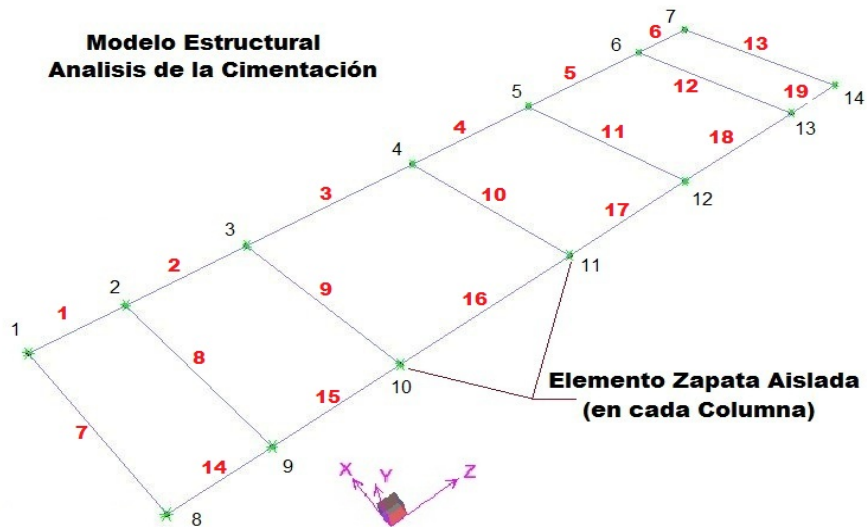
Modelo de Análisis Estructural de la Cimentación
